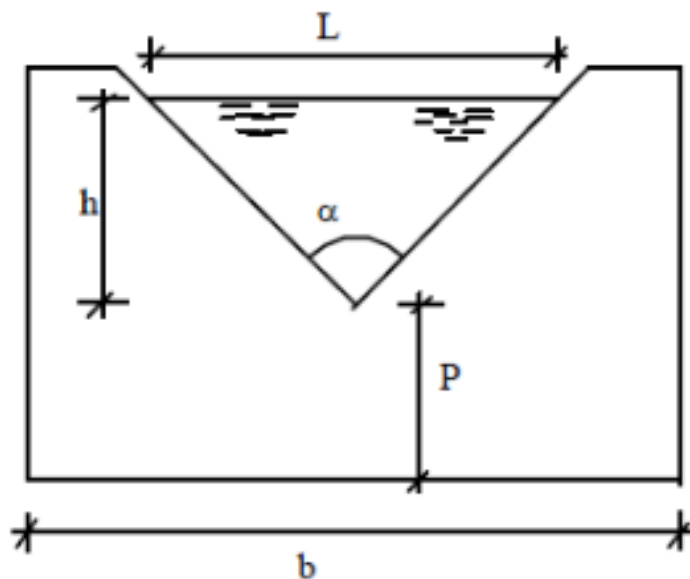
Medidor de vazão tipo vertedor triangular utilizado no monitoramento por instrumentação, nas barragens do PISF- Eixo Leste.
